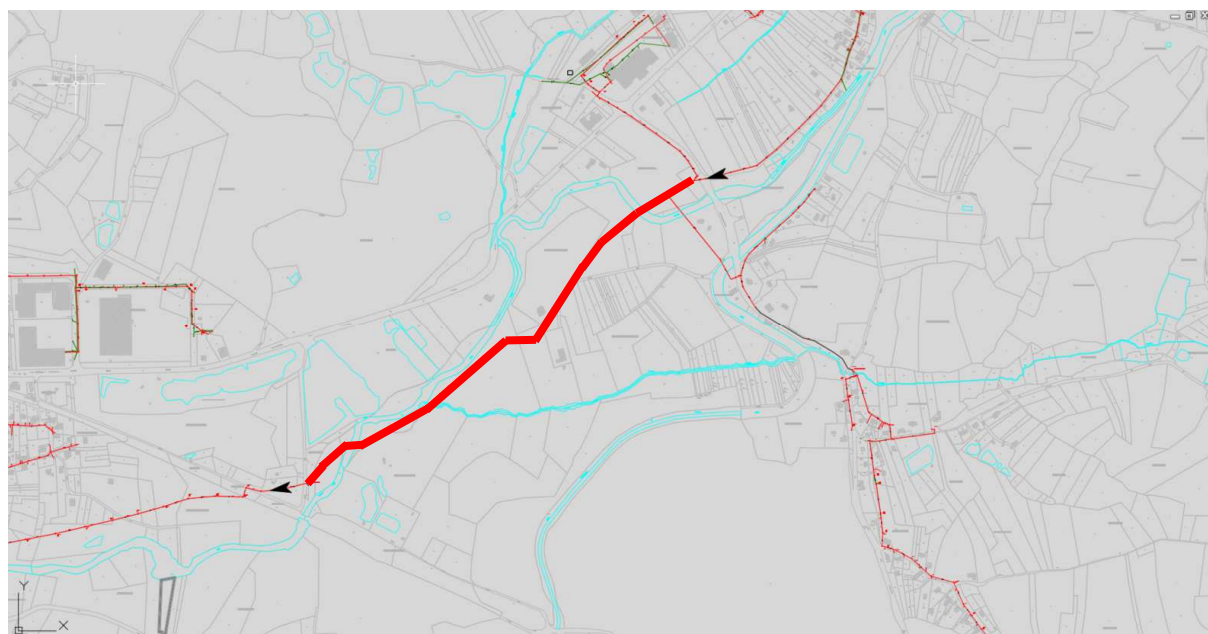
Localisation de la conduite de transfert entre Plancher-Bas et Champagny
